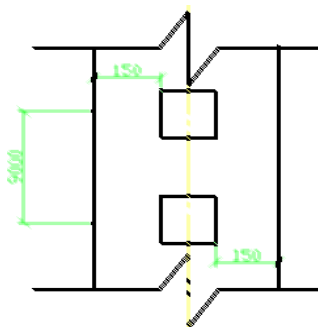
Схема розташування пальового фундаменту
